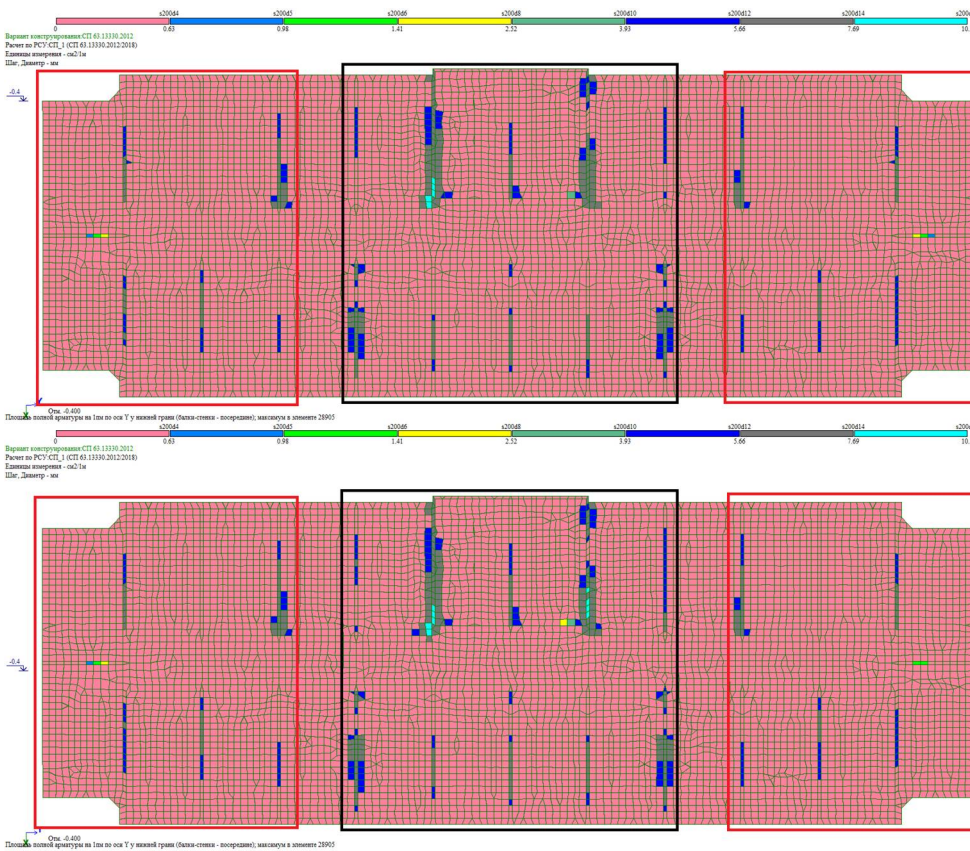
Площадь арматуры по оси Y у нижней грани. Верхнее изображение – без учета этапов возведения здания, нижнее – с учетом этапов возведения здания
